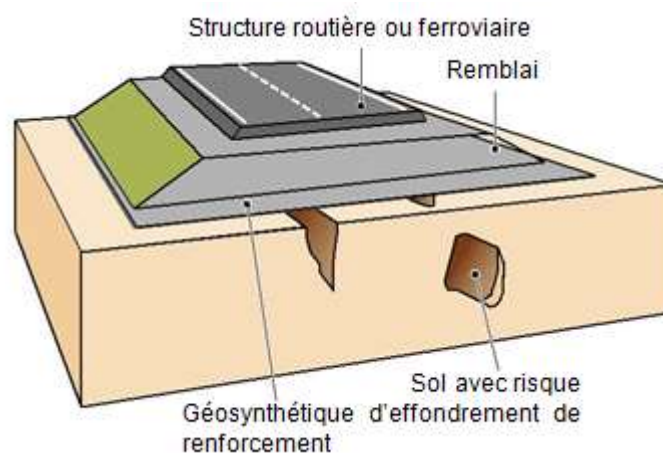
Application d'un géosynthétique de renforcement sur cavités
